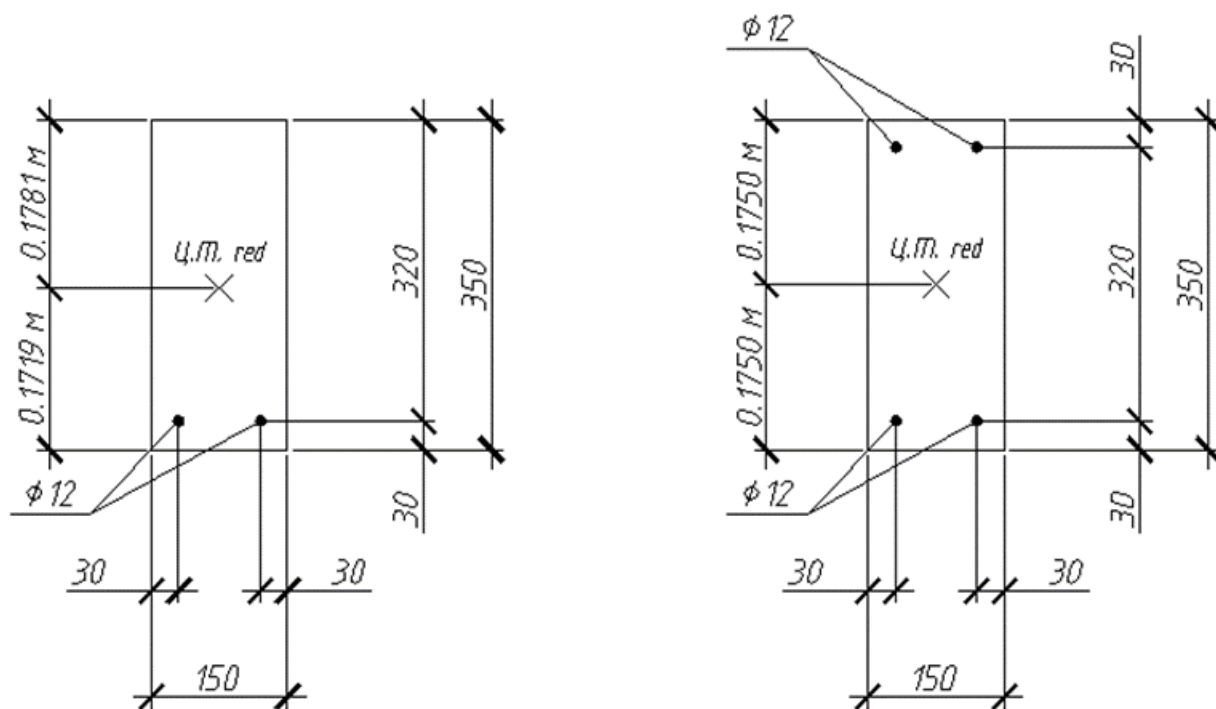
Поперечные сечения железобетонных элементов при несимметричном и симметричном армировании
